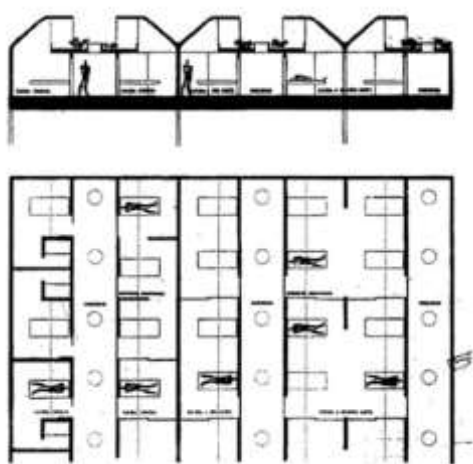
| Corte e planta esquemáticos do Hospital de Veneza.
